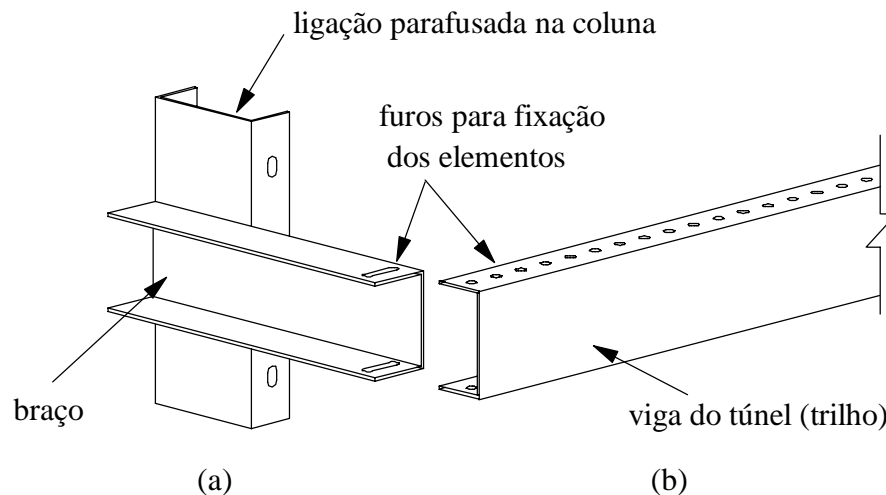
Configuração do braço e da viga do túnel (Águia (1999)); (a) Braço; (b) Viga do túnel.
